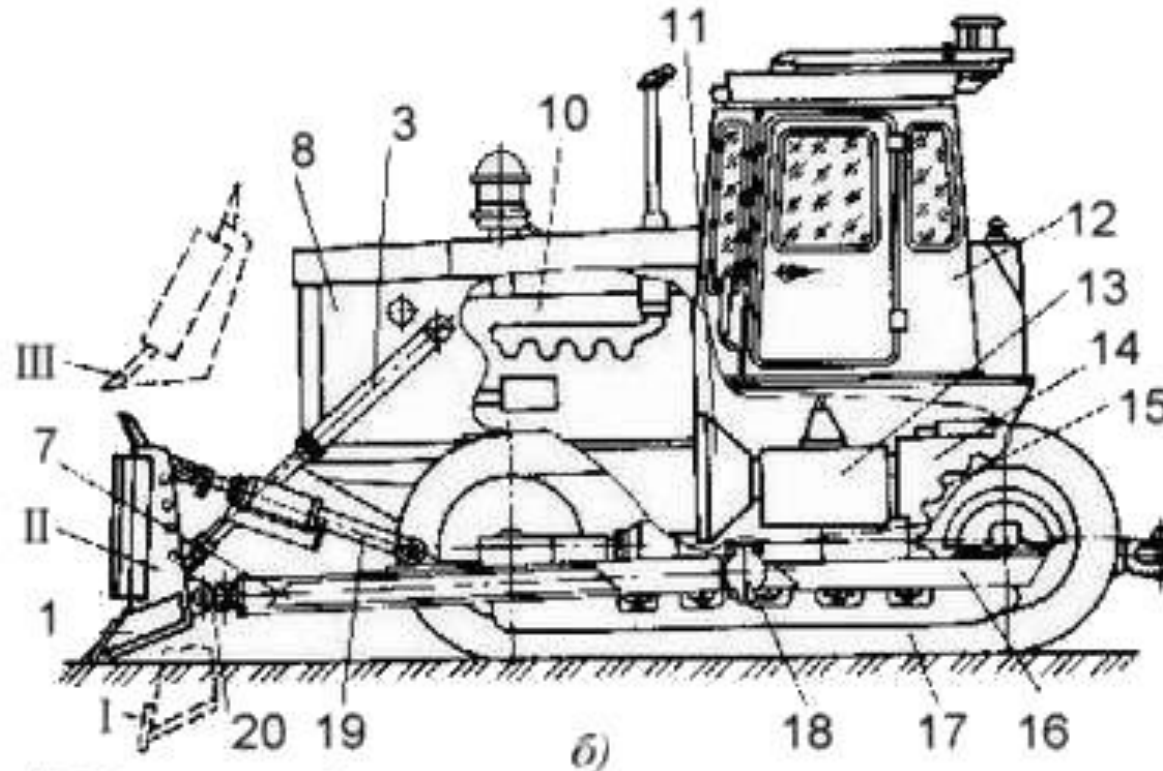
Гусеничный бульдозер с неповоротным отвалом с шарнирными брусьями: 1 - отвал, 2 - несущая рамка, 3 - гидроцилиндр подъема-опускания отвала, 4 - рукав, 5 - подрамник, 6 - поперечная балка, 7 - толкающий брус, 8 - трактор, 9 - нож, 10 - двигатель, II - муфта сцепления, 12 - кабина, 13 - коробка передач, 14 - задний мост, 15 - звездочка, 16 - гусеничная тележка, 17 - гусеница, 18 - шарнир, 19 - гидрораскос, 20 - универсальный шарнир; положения отвала: I - нижнее, II - рабочее, III - транспортное
